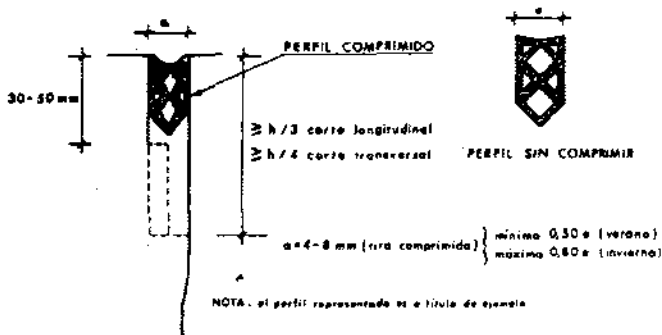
ESQUEMAS DEL SELLADO DE JUNTAS EN PAVIMENTOS DE HORMIGÓN VIBRADO
